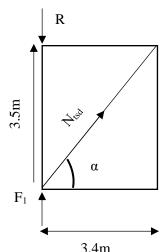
Schéma statique d'une partie de la poutre au vent de pignon arrière
